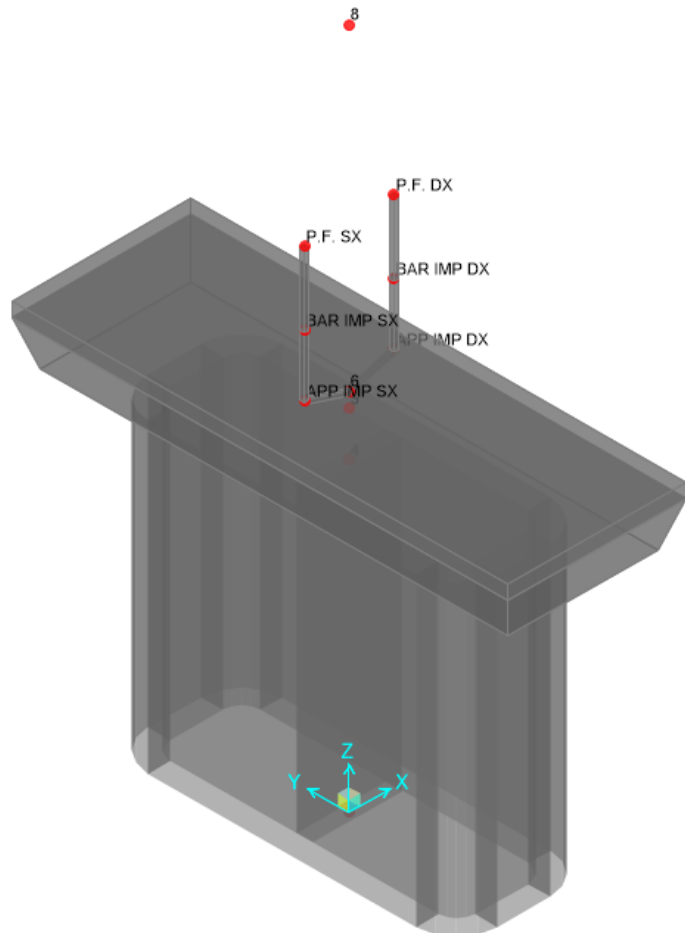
Vista estrusa del modello di calcolo delle pile
